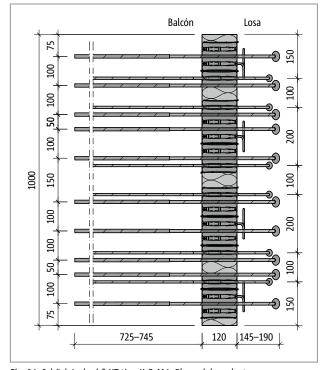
Schöck Isokorb® XT tipo K-O-M4: Plano del producto
